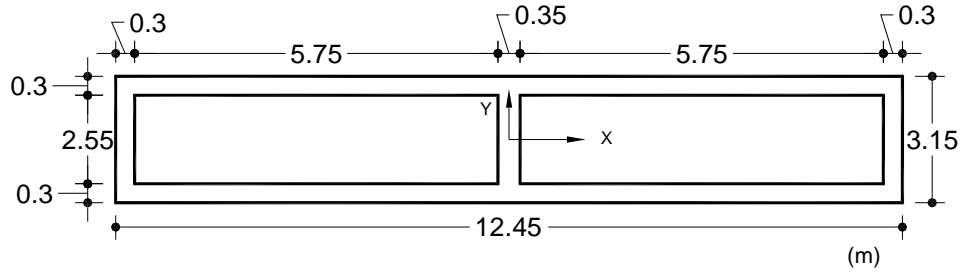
Sección 3 de la columna 12. (No. 12)
